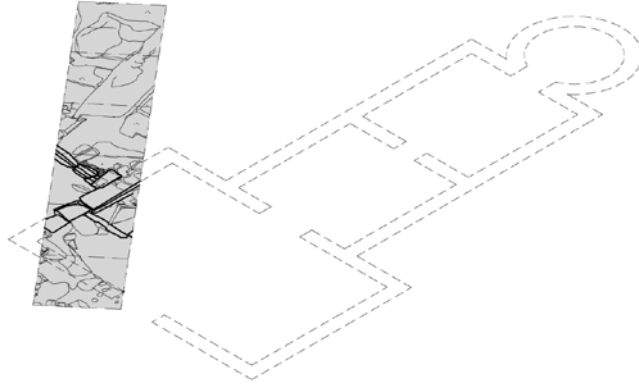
Esquema de implantação do edifício sobre a planta da área intervencionada
